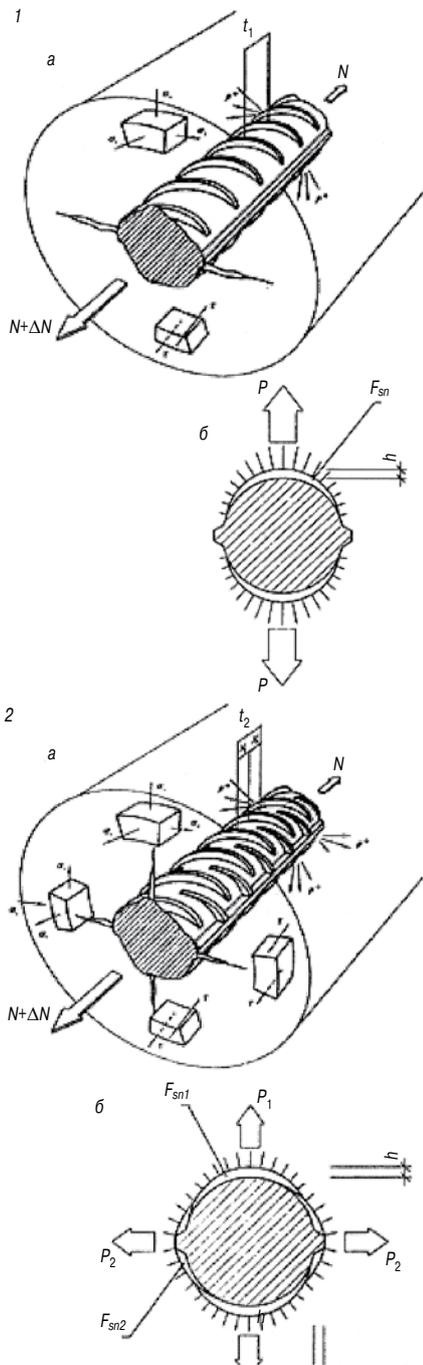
Схема взаимодействия растянутого стержня с окружающим бетоном: 1 – европейский профиль с серповидными ребрами; 2 – профиль нового типа; а – усилия в бетоне в зоне передачи напряжений с арматуры на бетон; б – распределение усилий распора в поперечном сечении
